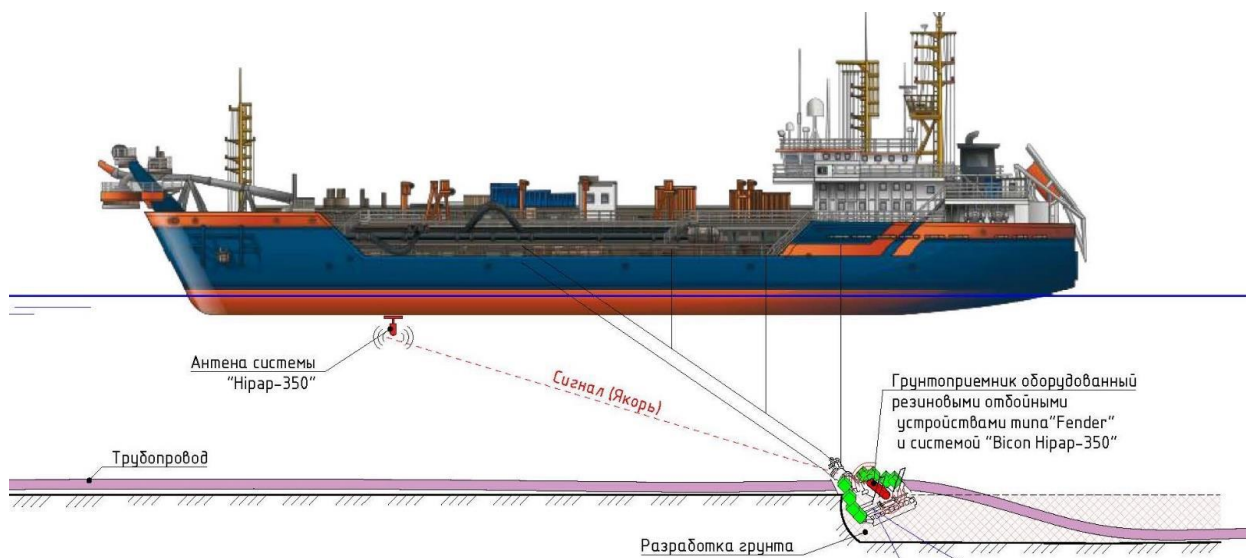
Схема разработки грунта с помощью самоотвозного земснаряда
